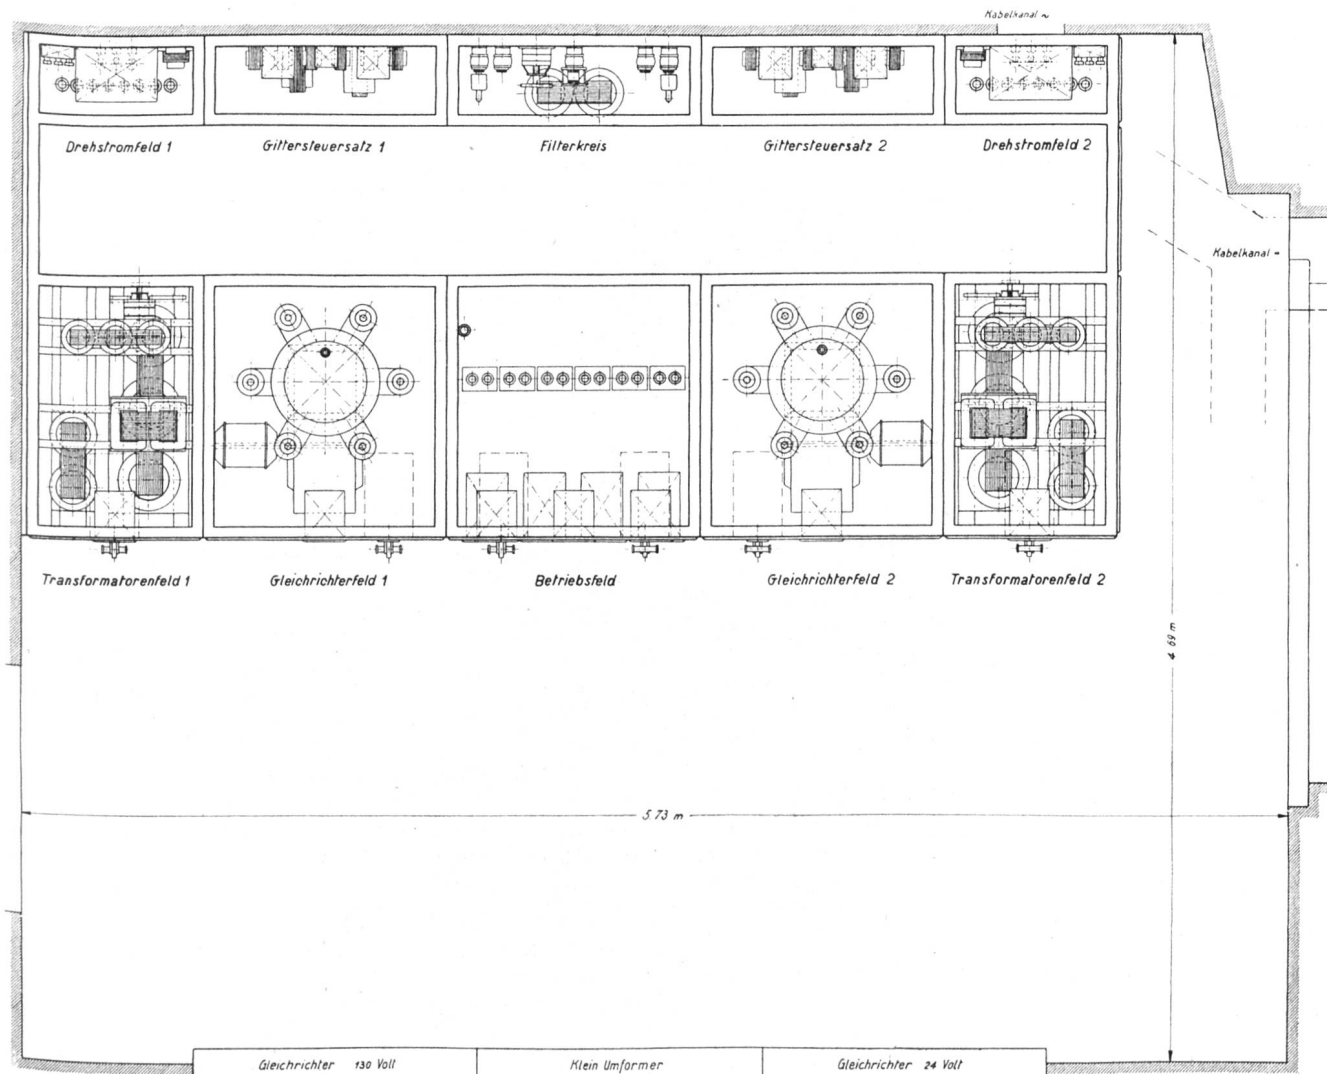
Grundriss der Anlage Bern-Ortsbetrieb — Plan de l'installation, service local Berne
